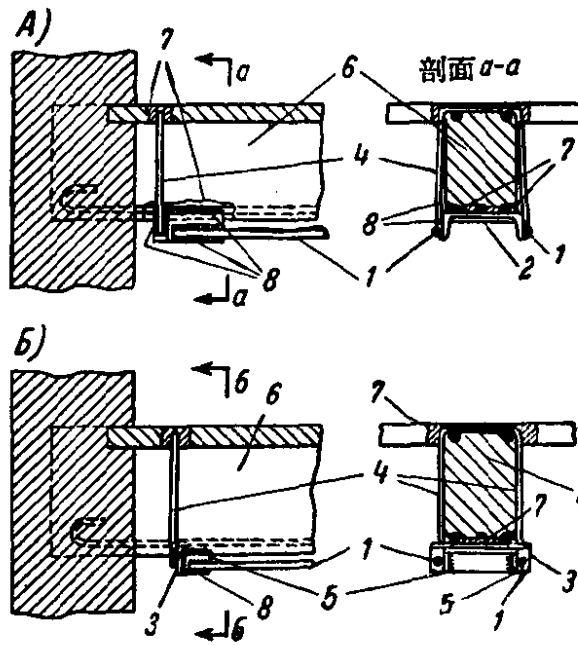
钢筋混凝土构件边支座上水平补强拉杆的锚固装置结构
